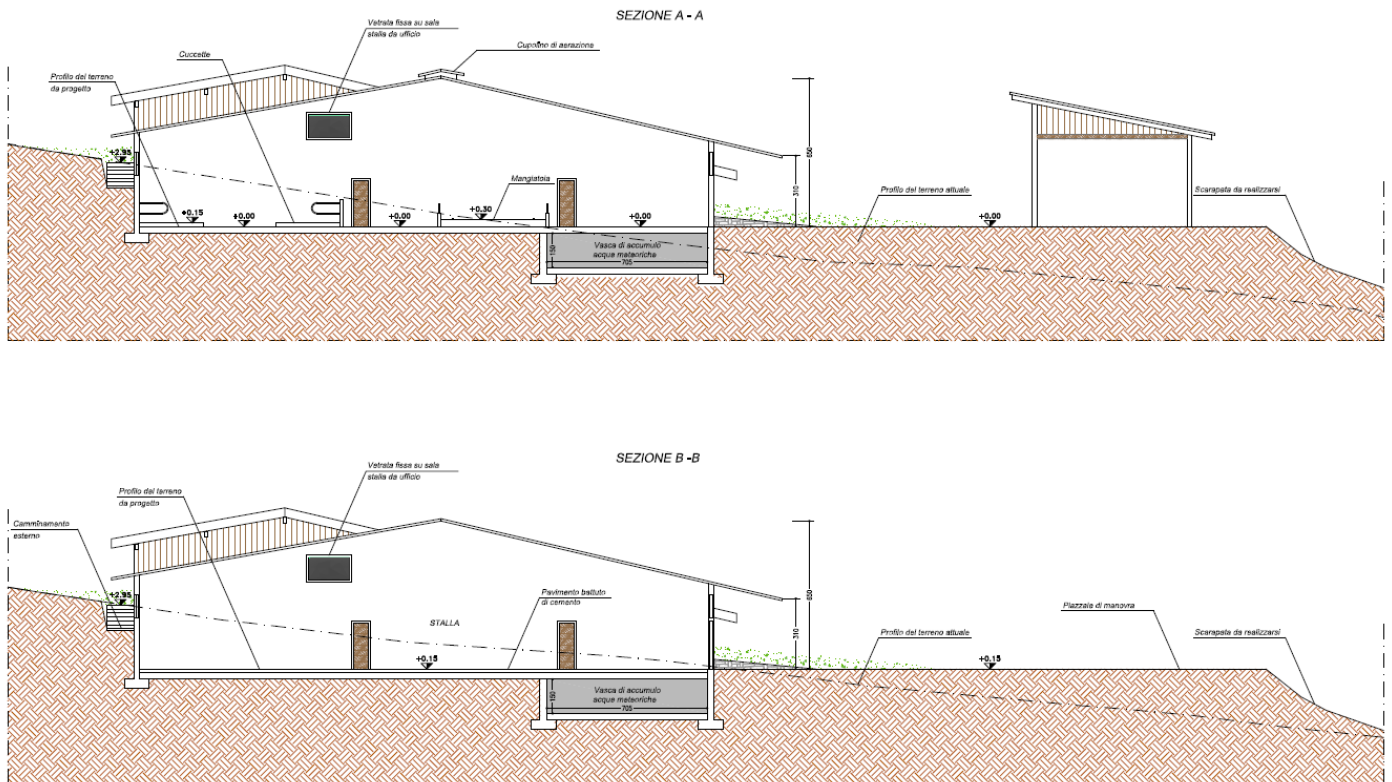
Stralcio sezioni A-A e B-B di progetto
